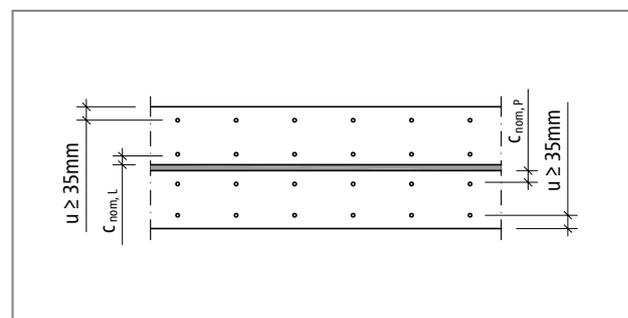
Schöck Tronsole® Typ F: Vertikalschnitt quer zur Treppe im Bereich des Konsolauflegers; Darstellung der Betondeckung  $c_{nom,L}$ ,  $c_{nom,P}$  und des Mindestachsabstandes  $u$  der Bewehrung
